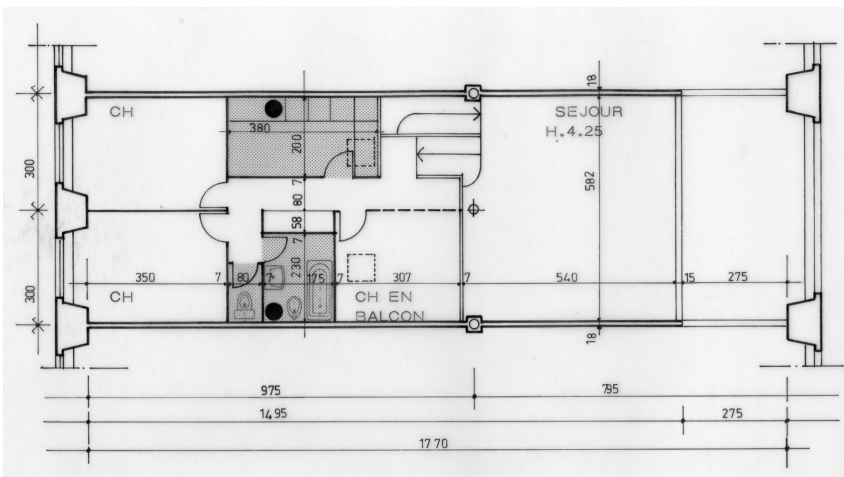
Plan configuration B 1/200 - Logement 4 pièces
